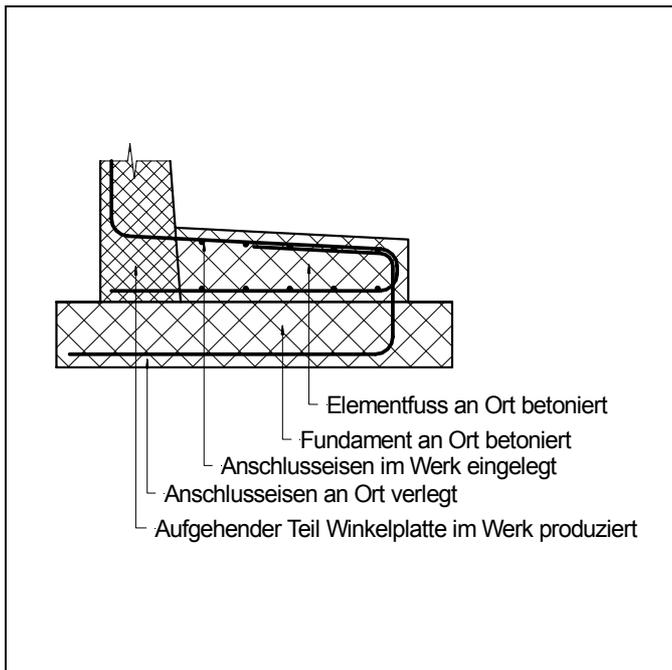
Anschlussseisen des Elementfusses mit Fundamentbewehrung verbunden.
